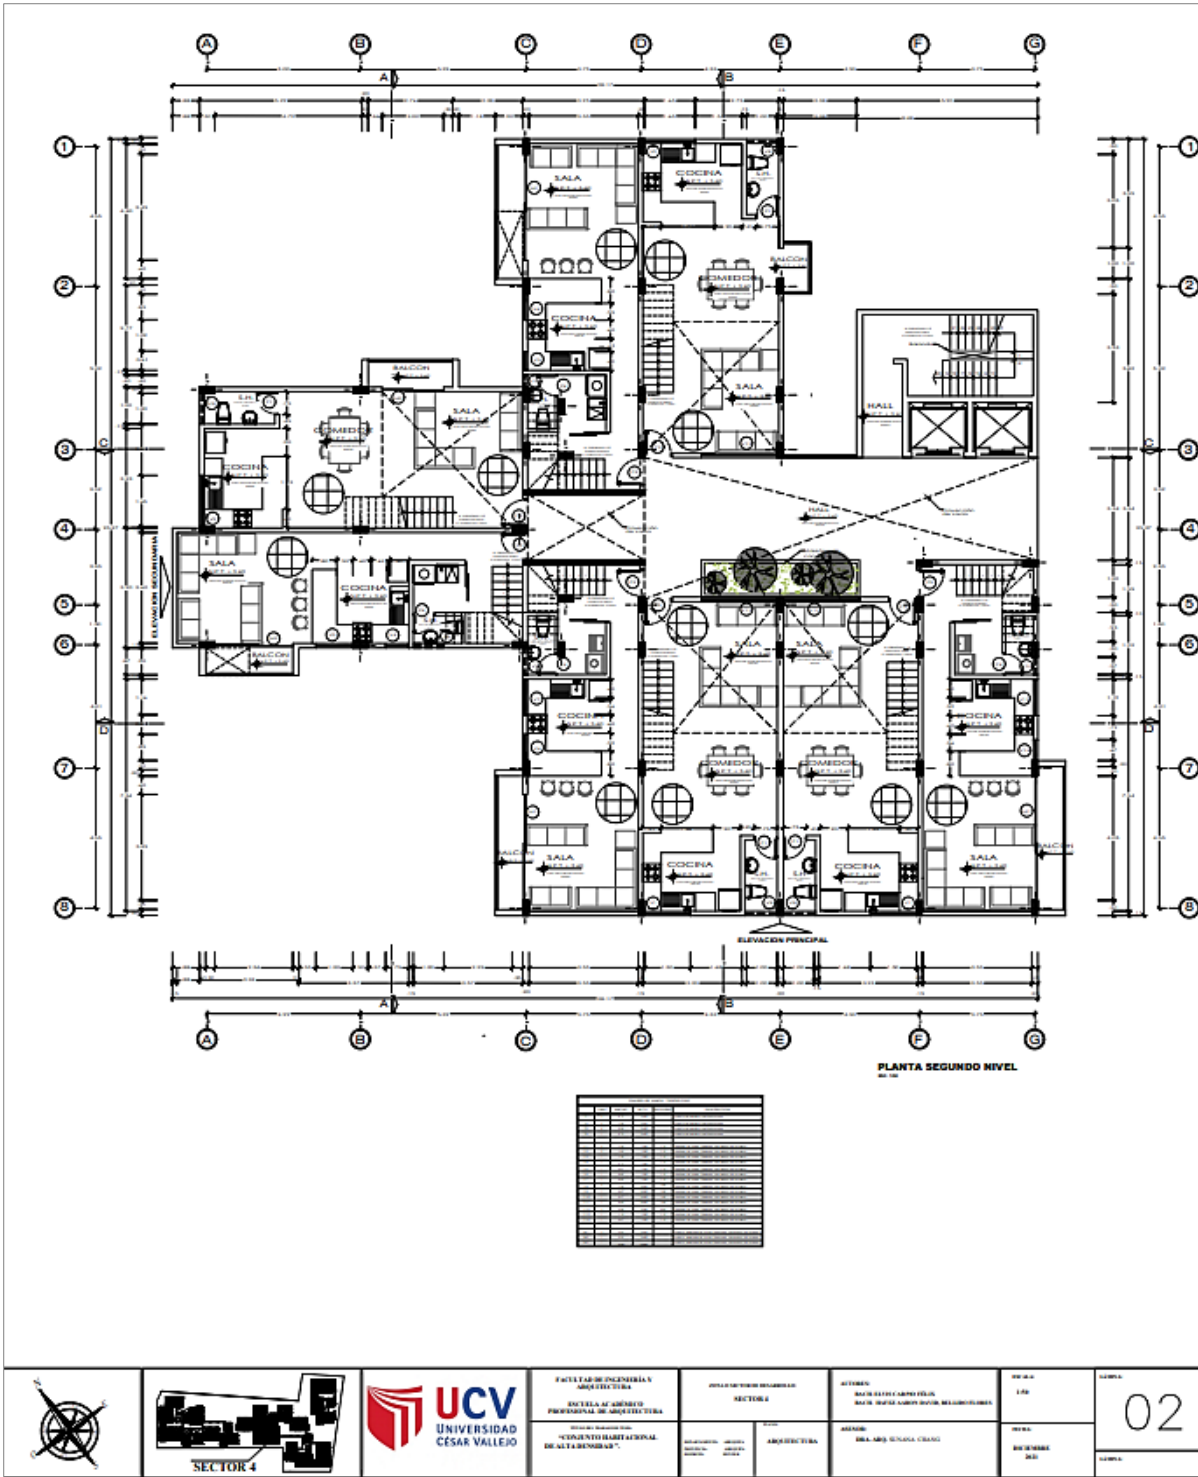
Planos de Arquitectura – 02 - Bloque 4 – Segundo Nivel
